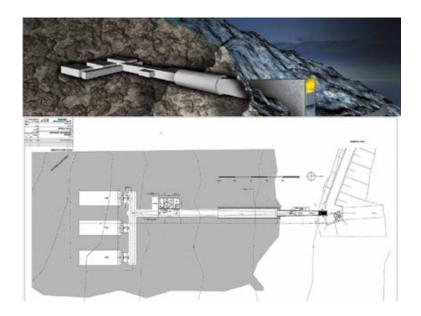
Rendering und Grundriss des Global Seed Vault
